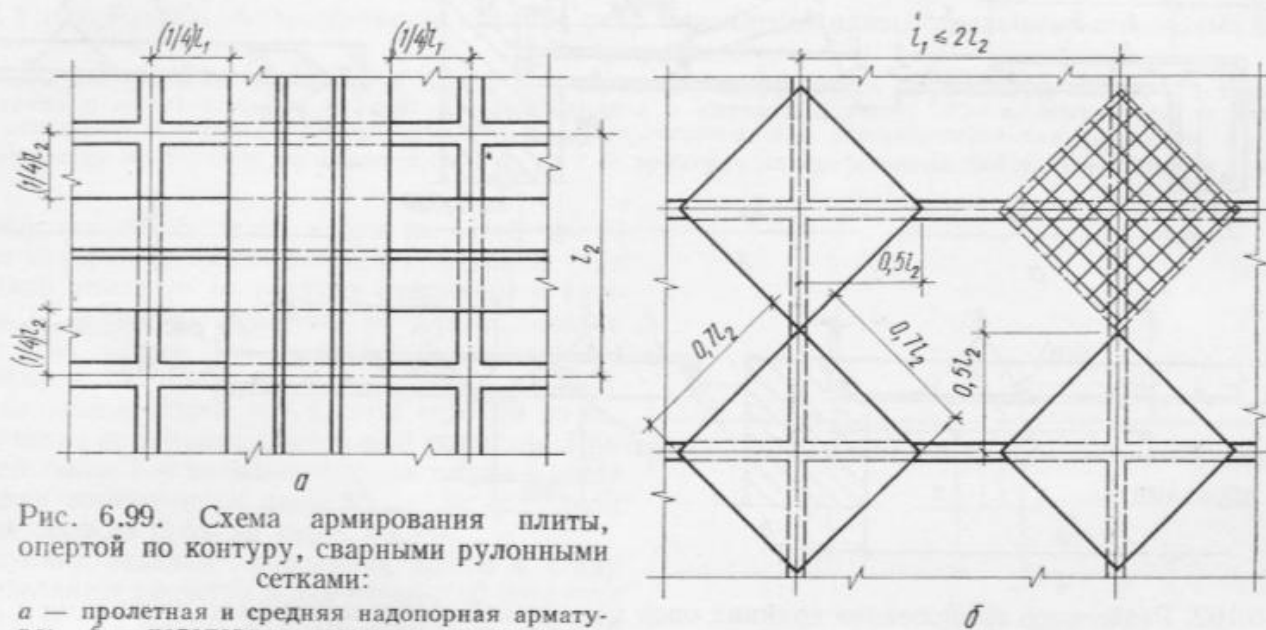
Схема армирования плиты, опёртой по контуру, сварными рулонными сетками:
